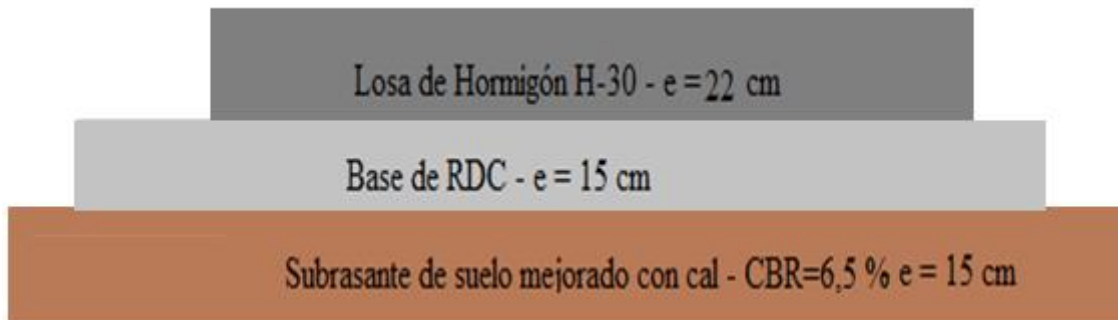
Esquema del paquete estructural propuesto (fuente: elaboración propia).
